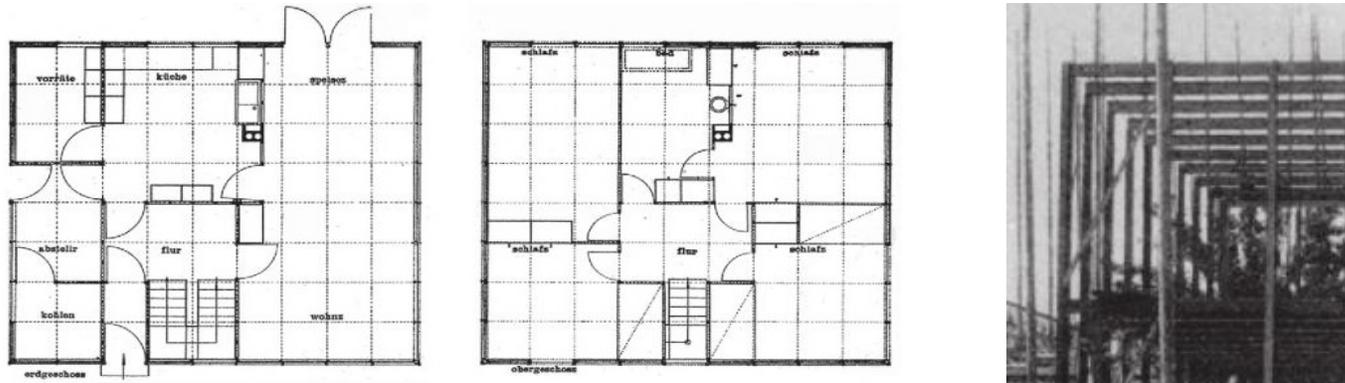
Walter Gropius Haus Nr. 17, Grundrisse
